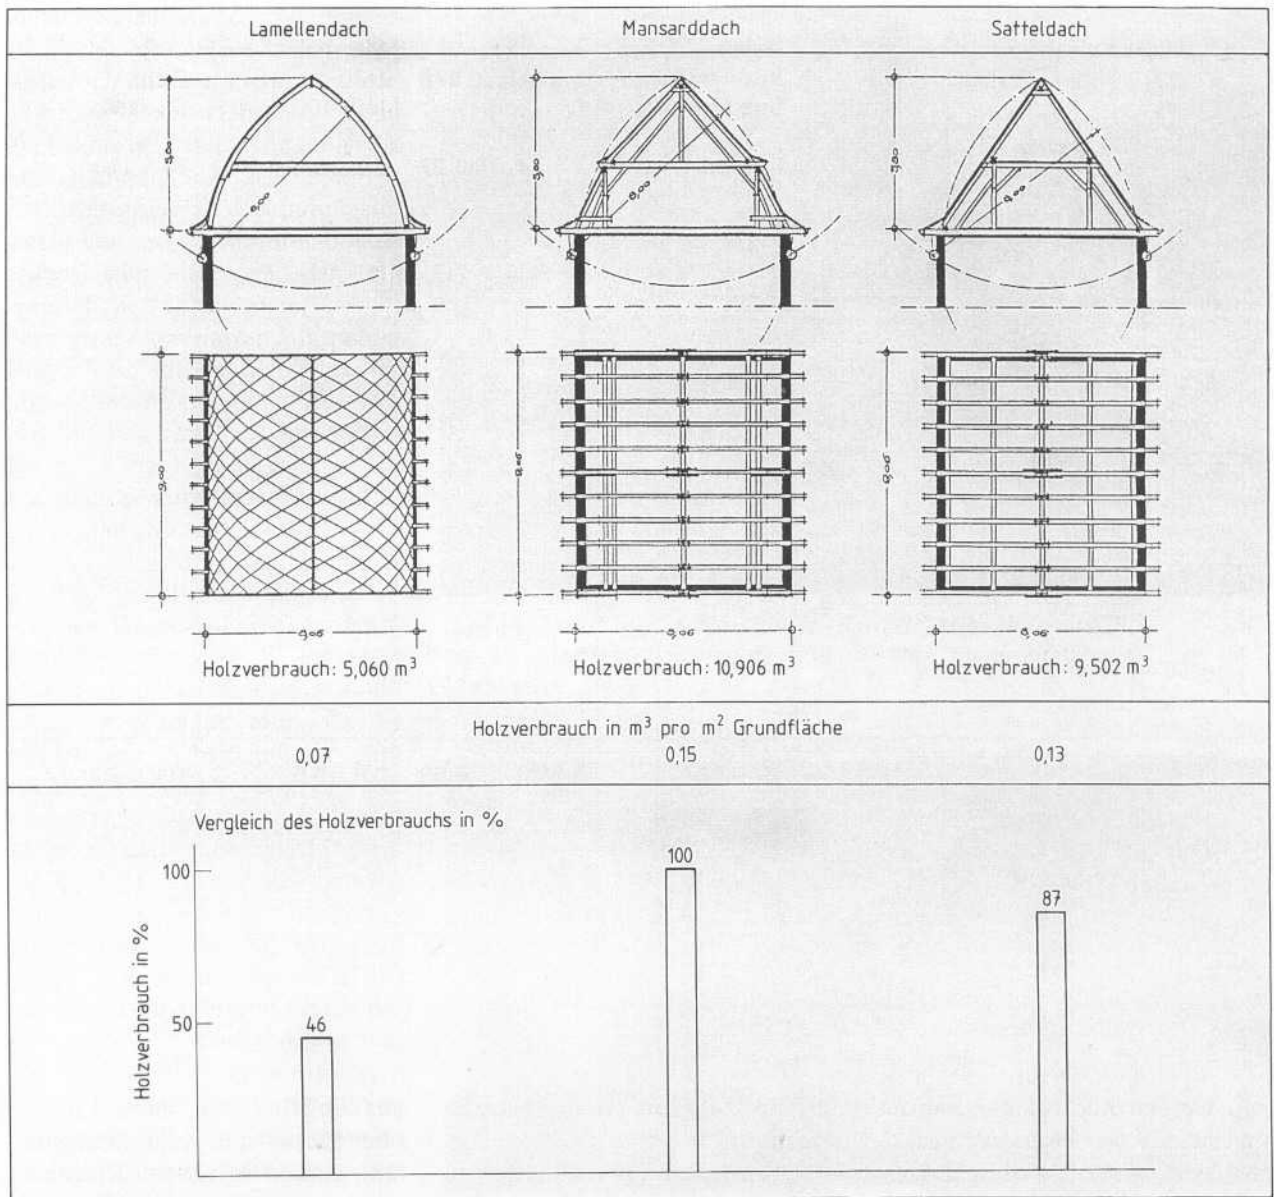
Vergleich Lamellendach mit traditionellen Dachtragwerken für Hausdächer
